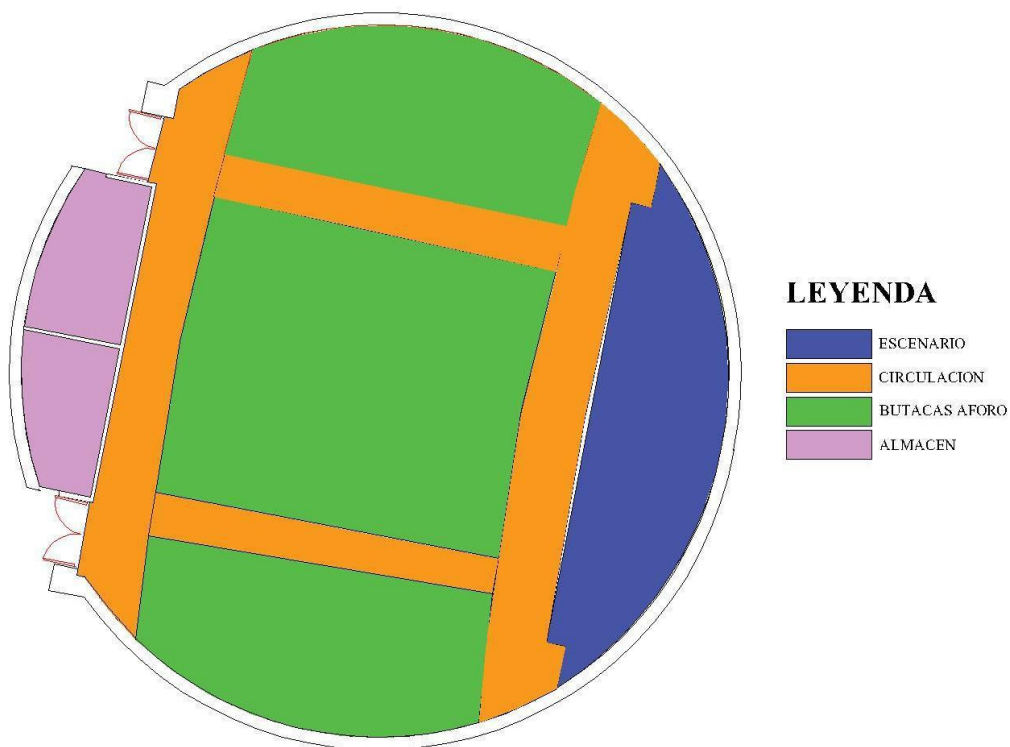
Zonificación Planta Baja Salón de Actos-Fuente: Elaboración Propia
